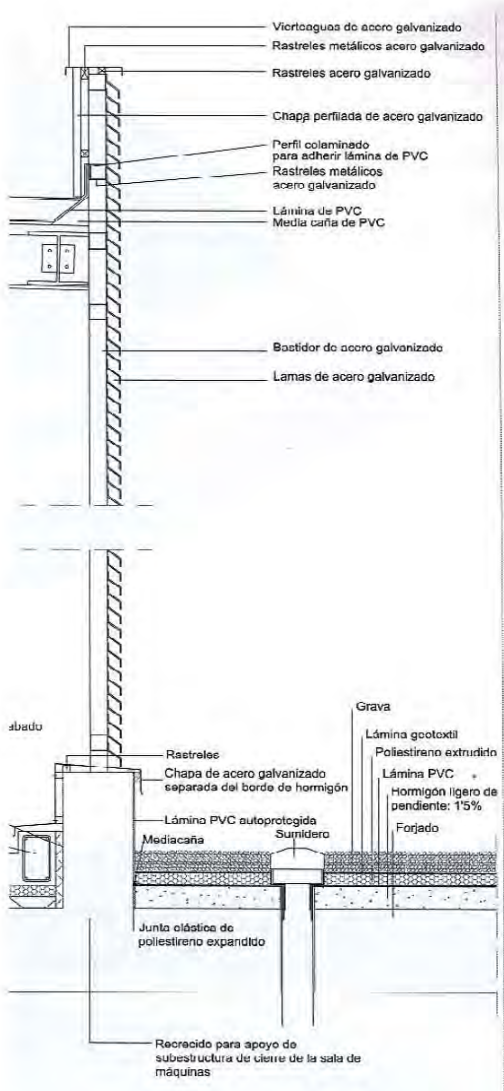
Detalle de colocación de rebosadero en el cerramiento perimetral de la cubierta
